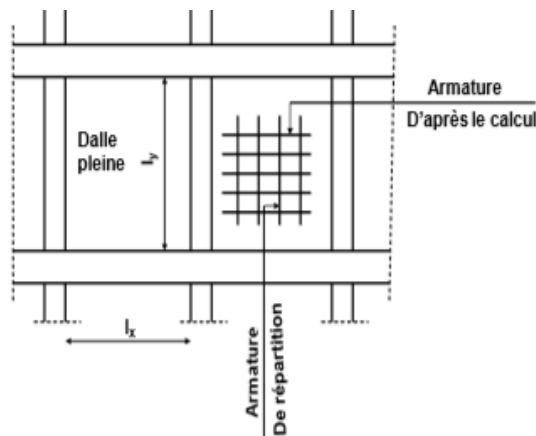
disposition du ferrailage d'une dalle qui travaille dans un seul sens
